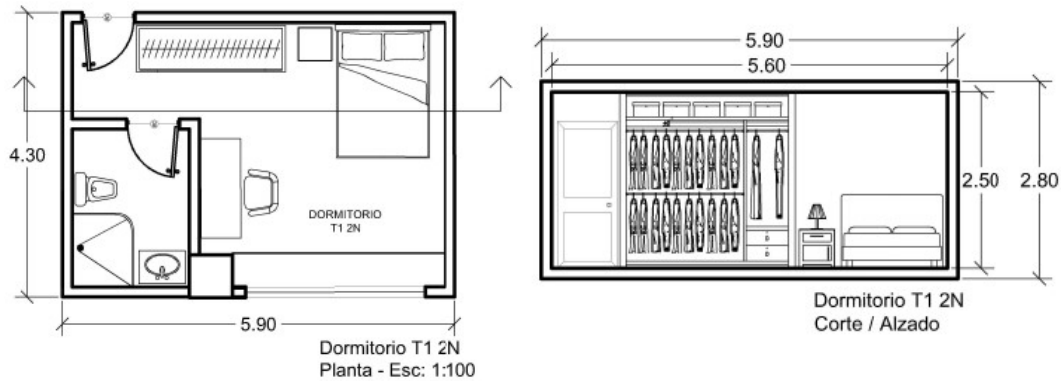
Planta y alzado de dormitorio individual con baño completo esc 1:100
